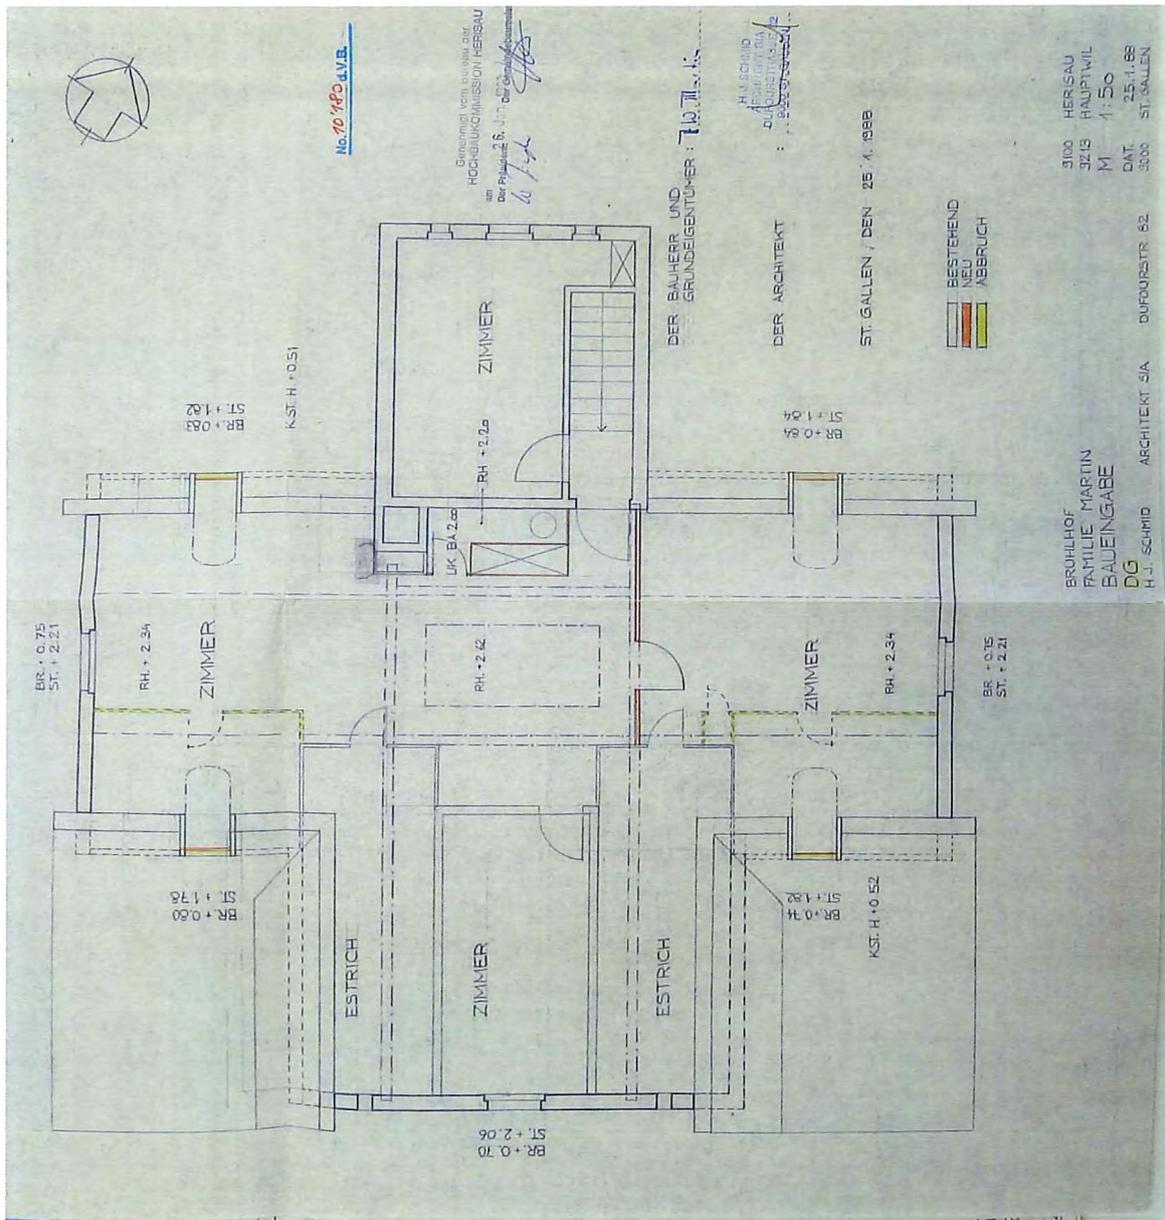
Baueingabe „Sanierung Wohnhaus“ Nr. 10'180 1988, zur Parzelle 523. Baueingabearchiv Gemeinde Herisau. Grundriss 2. Dachgeschoss mit projektiertem Ausbau.
